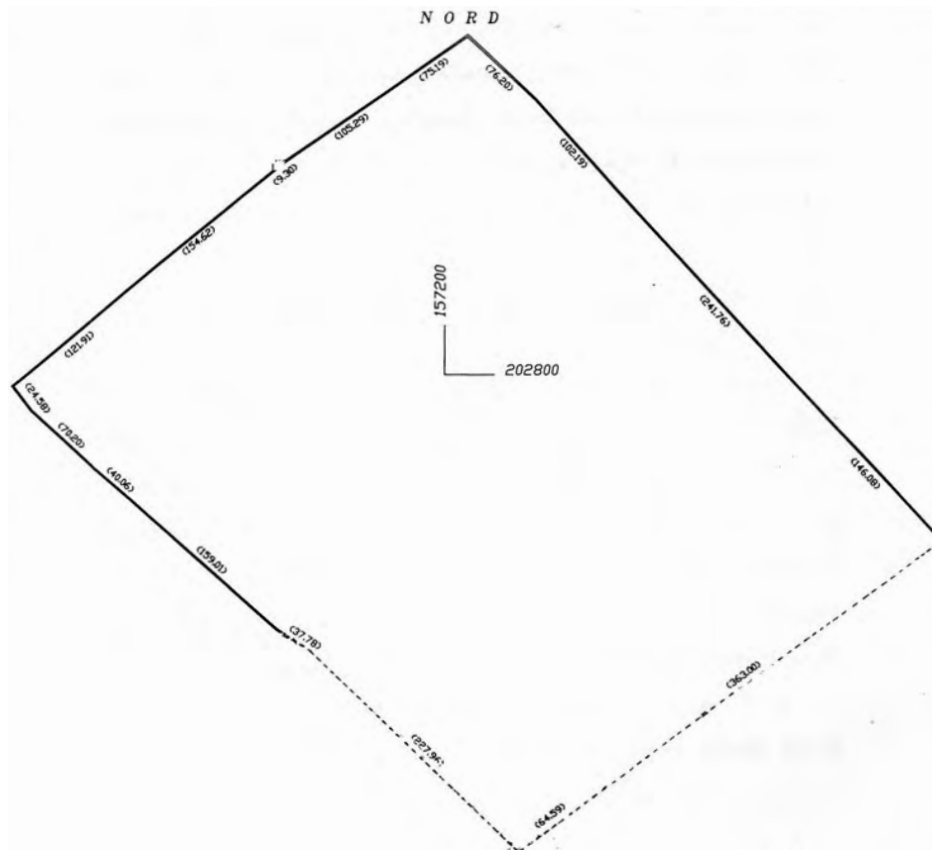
Levantamento do traçado das muralhas de Cernu. / Plan relevé du tracé des murailles de Sernou.
